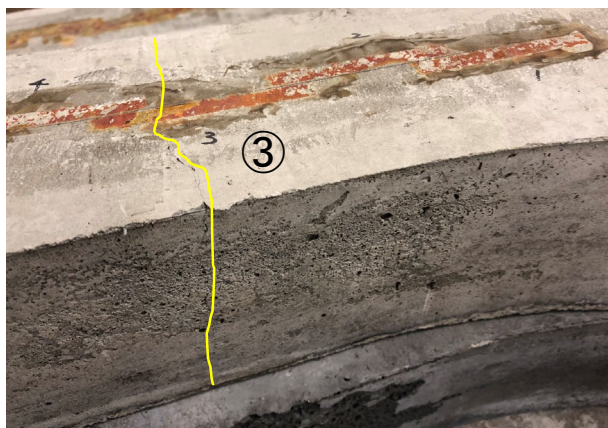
ひび割れの発生状況(No.1 SFRC, ひずみゲージ③付近)
